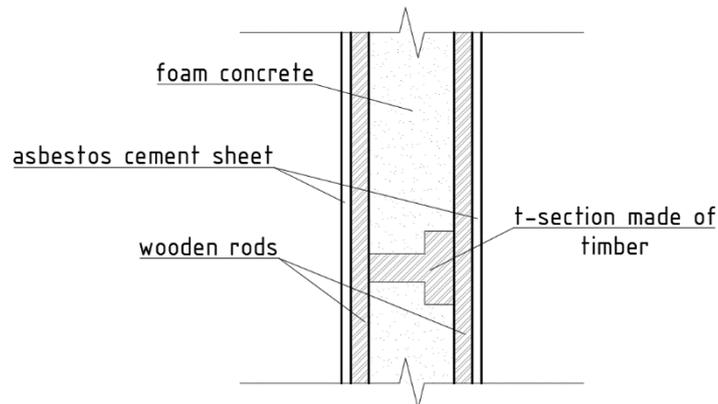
Вертикальное сечение стены здания с деревянным каркасом и утеплением пенобетоном
